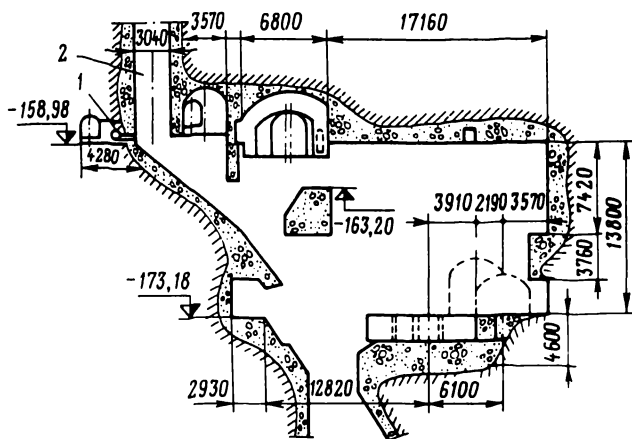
Конструктивные параметры камер подземного грохотно-дробильного комплекса:
